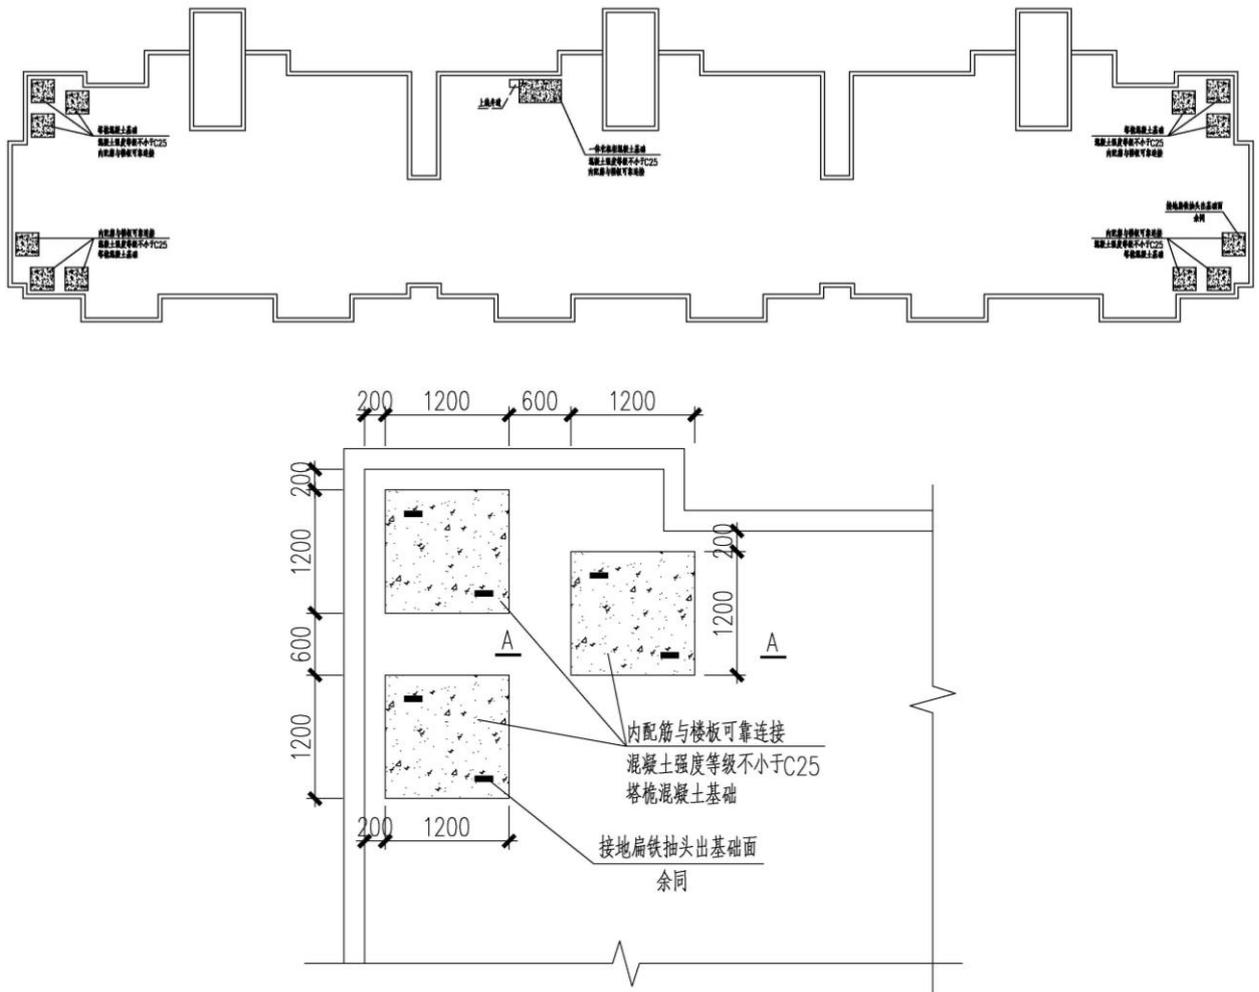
平屋面屋面设施（预留混凝土基础建设方式）平面布置图
